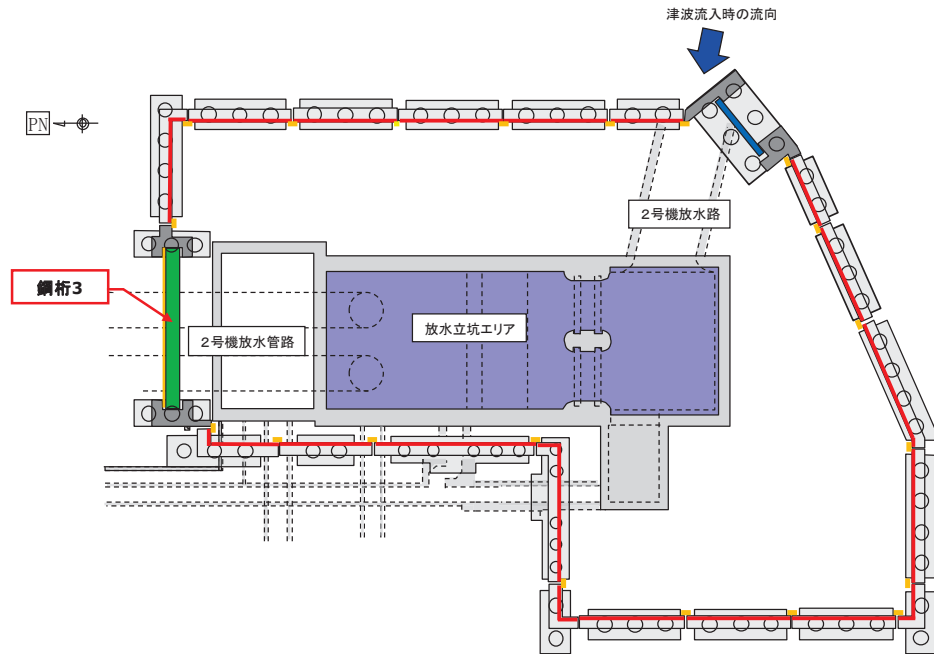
鋼製遮水壁（鋼桁）の配置図
